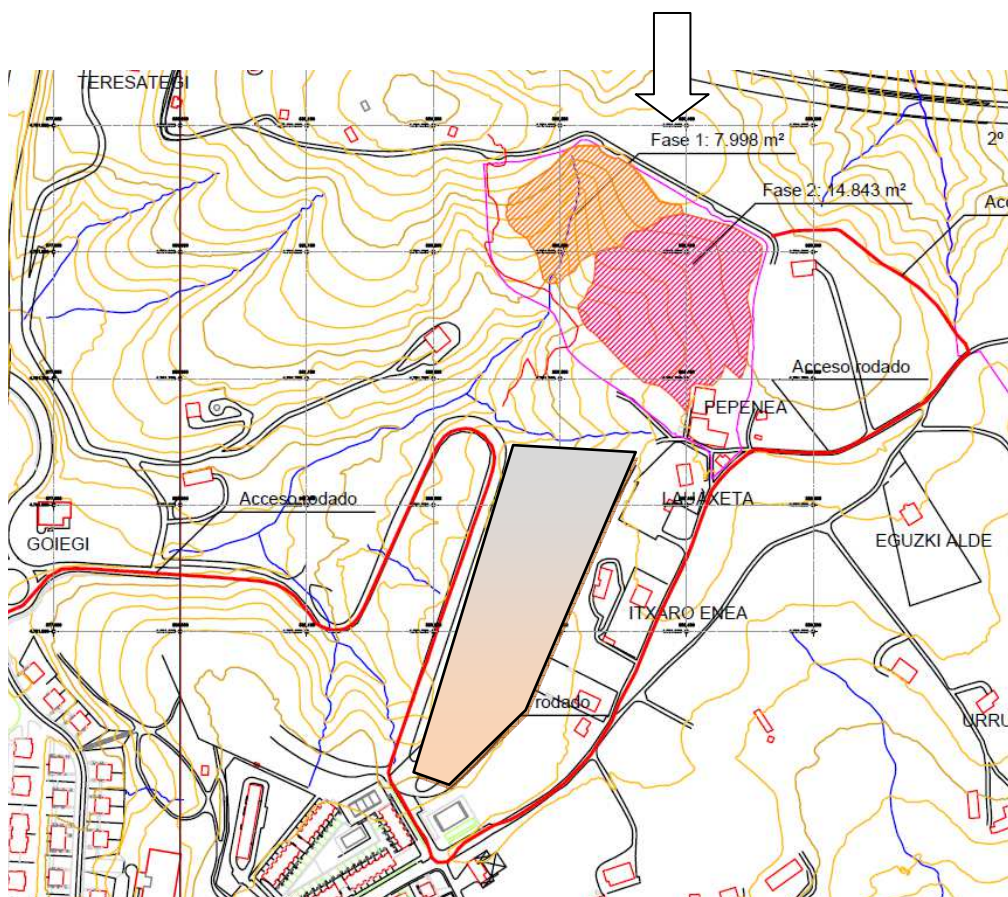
Ubicación en planta de Proyecto y accesos previsto para el transporte de material al mismo
